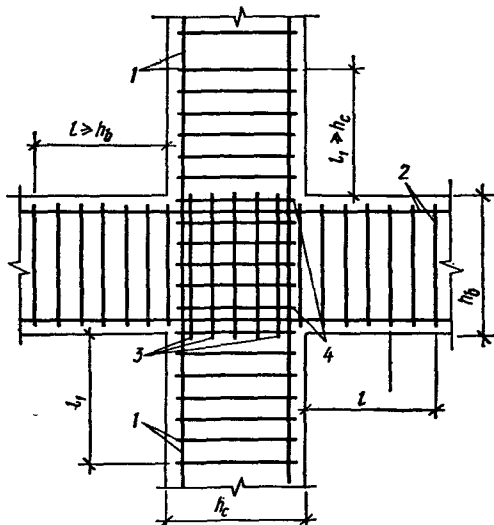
Армирование узла сопряжения железобетонного ригеля с колонной при интенсивных динамических воздействиях:
